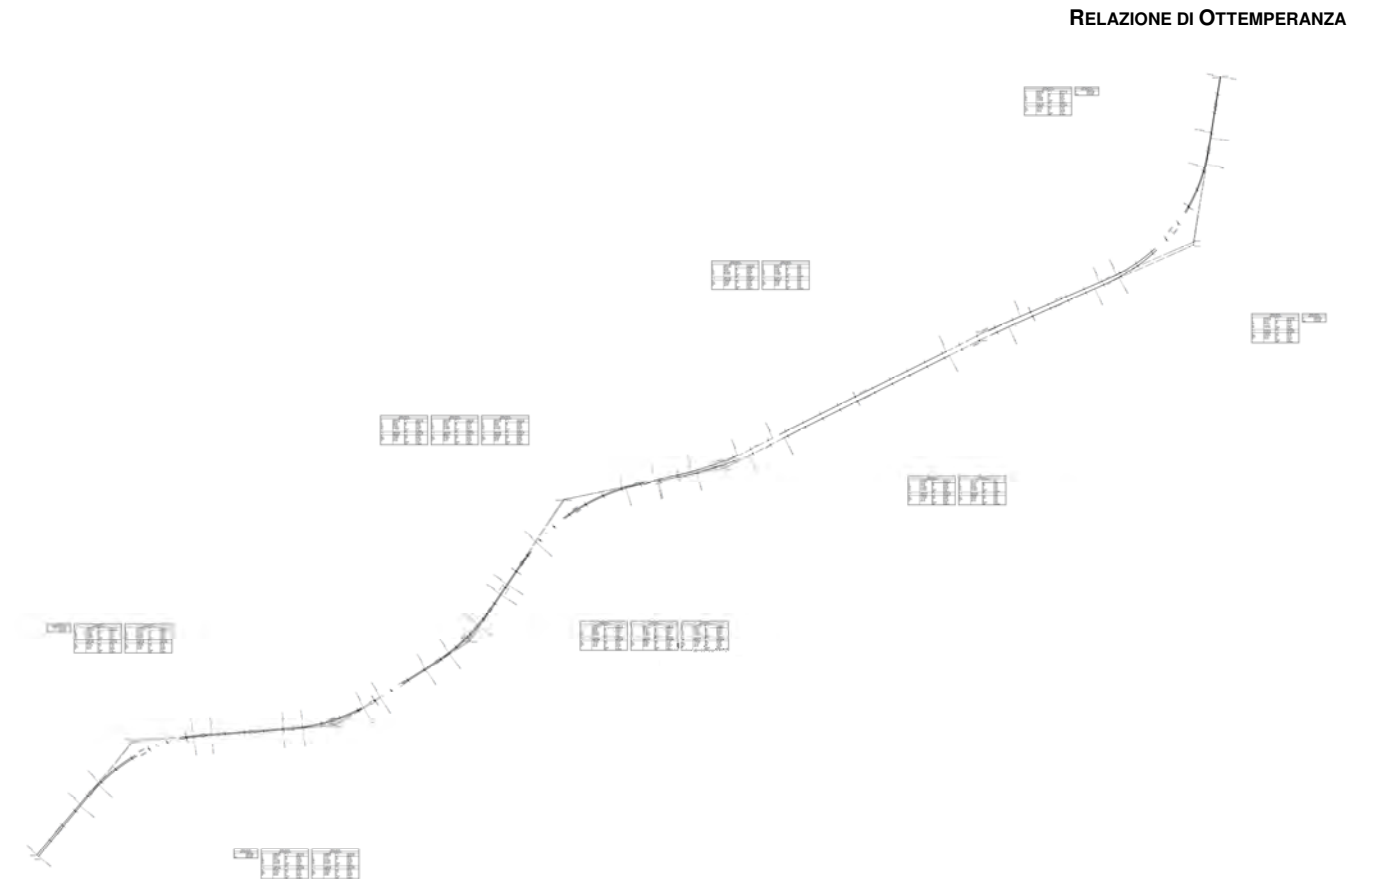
Elaborazione planimetria di tracciamento "Asse principale"
